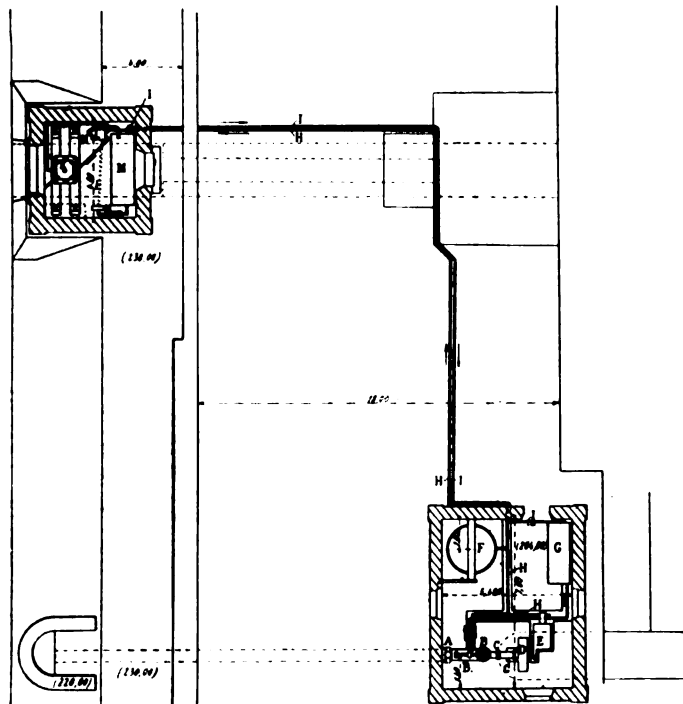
Plan des appareils de chasse des Cheurfas (Algérie).
